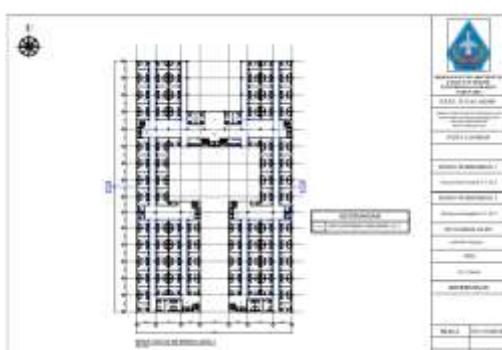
Denah Utilitas Air Bersih Lantai 4
